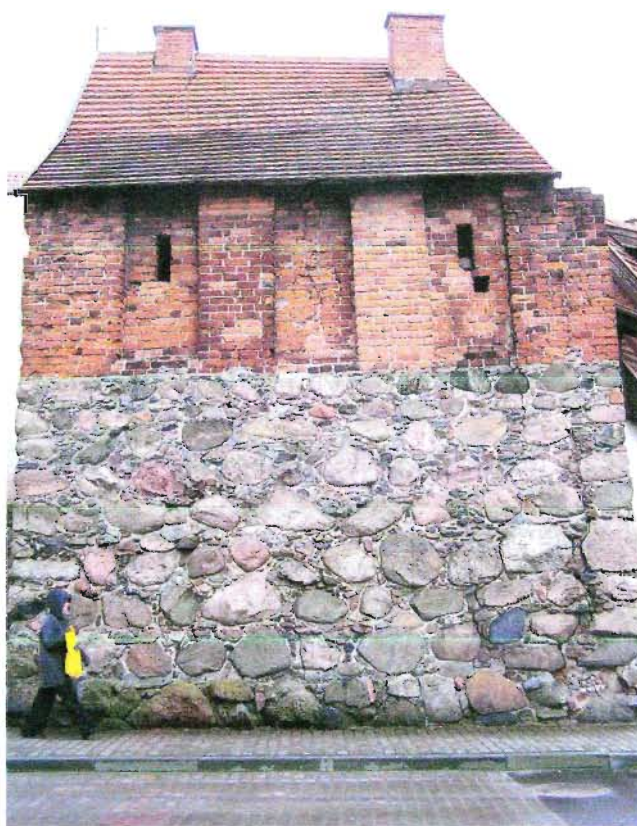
Widoki od zach. -fragmentów pld. części muru zachodniego z przyporami,
